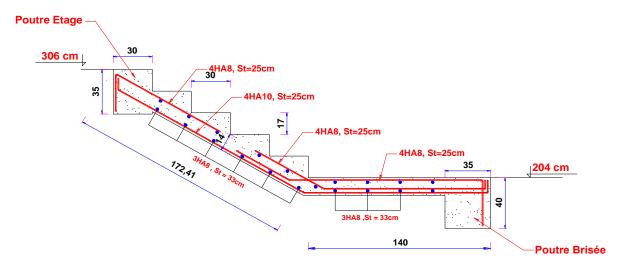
Schéma de ferraillage de l'escalier type (1)
